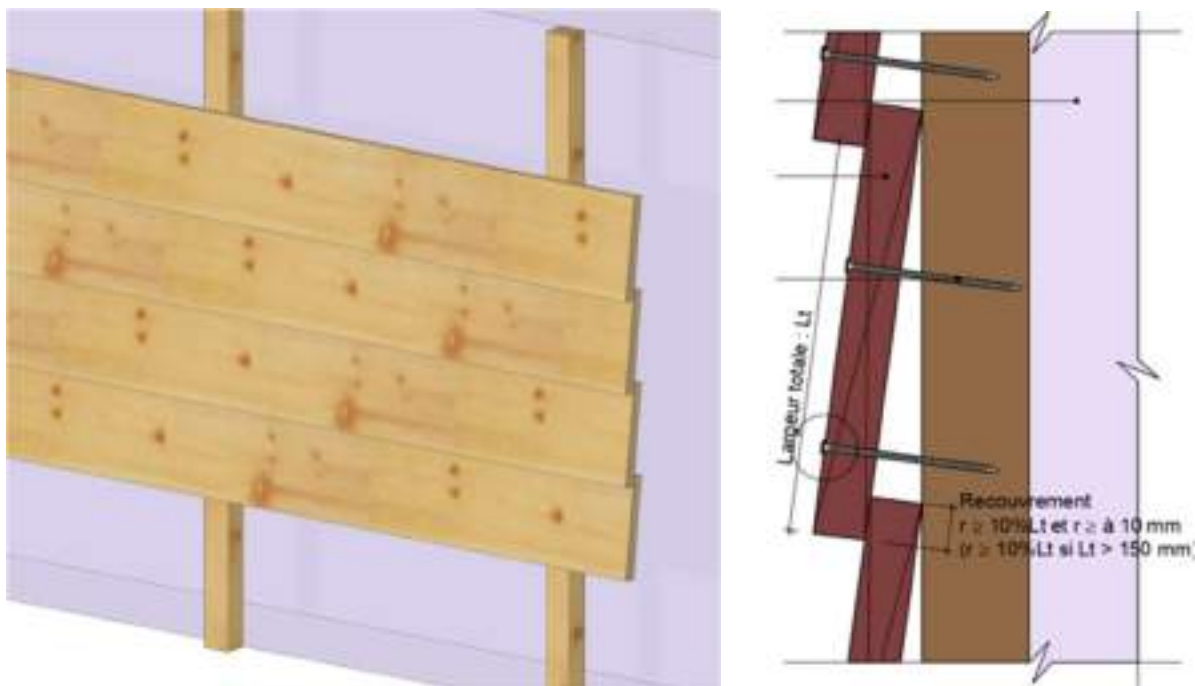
Lames à recouvrement – pose horizontale (illustration 3D et coupe verticale)
